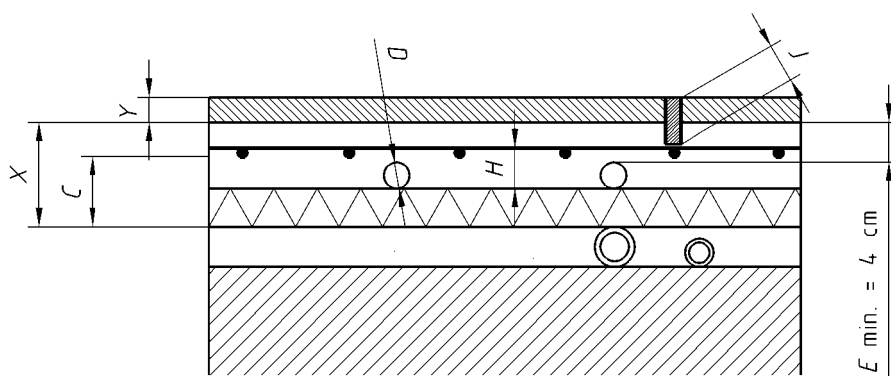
Plancher chauffant en dalle désolidarisée isolée,
